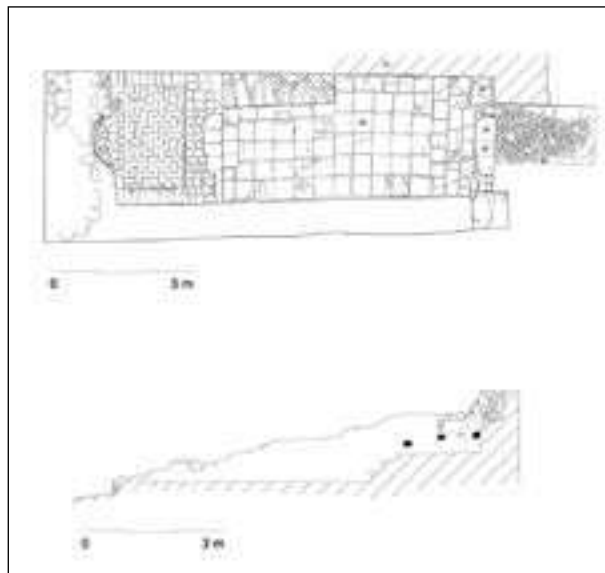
Planta y sección de la capilla (Alejandro Pérez-Malumbres Landa y Teresa Soria Trastoy)
